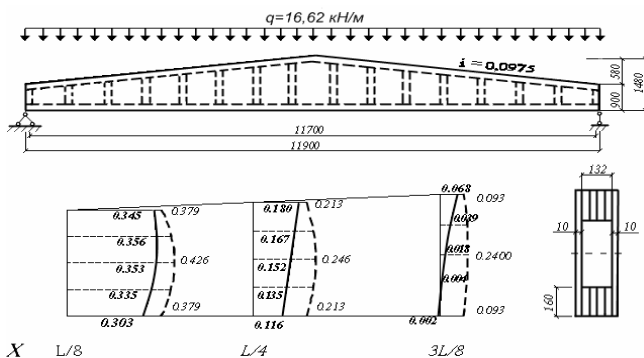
Конструкция балки и эпюры касательных напряжений по высоте стенки деревофанерной балки:
